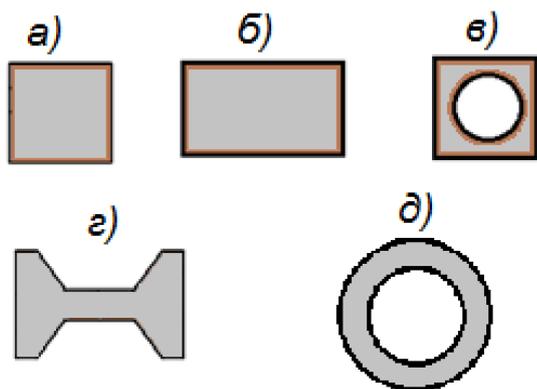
Поперечные сечения готовых свай заводского изготовления: а)- квадратные; б) – прямоугольные; в) - квадратные с круглой полостью; г) – двутавровые; д)- круглые с полостью(сваи оболочки)
